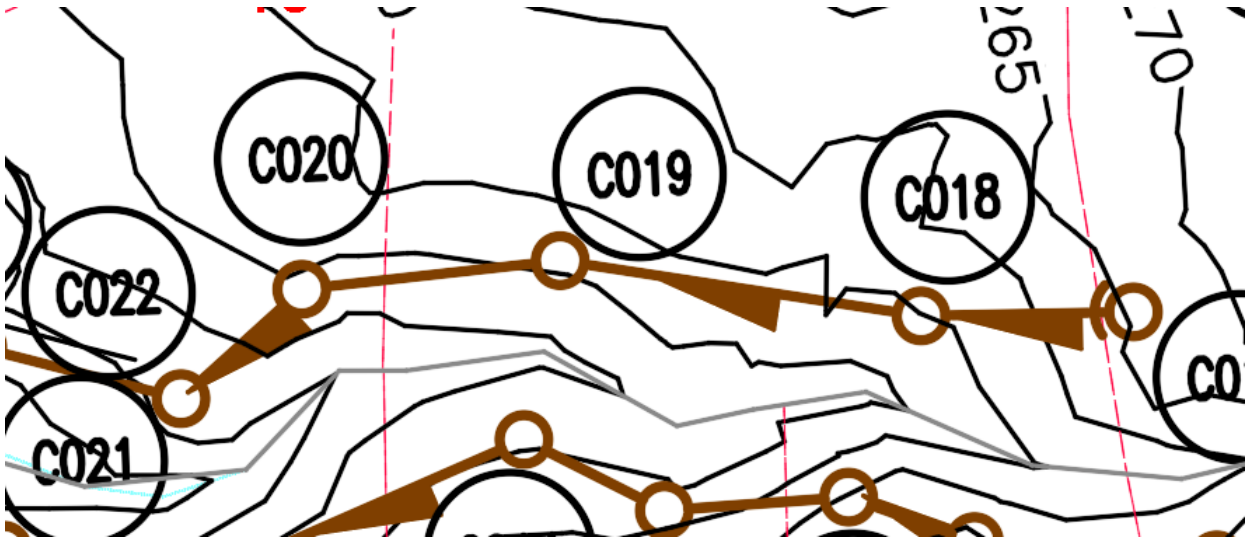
Ubicación en planta de las cámaras 19 y 20
